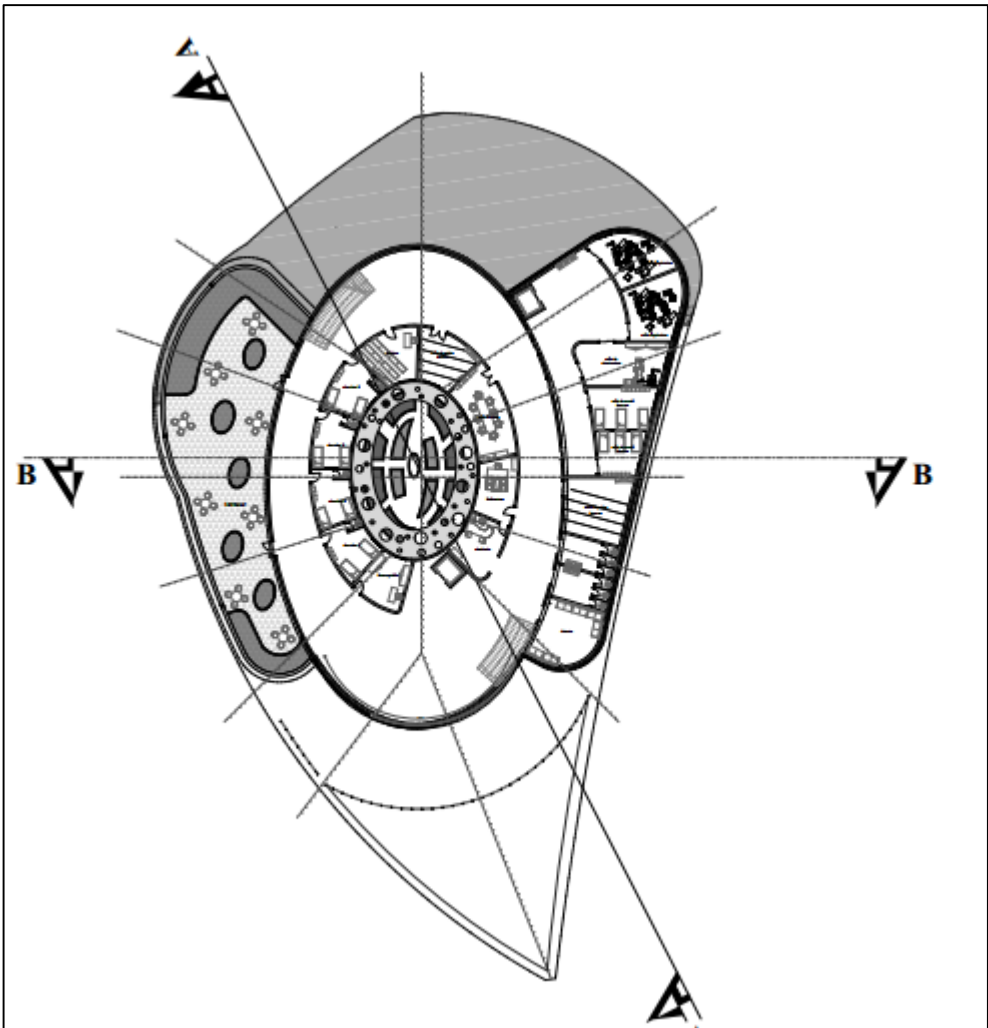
Plan 1ère Etage source : Auteur.
